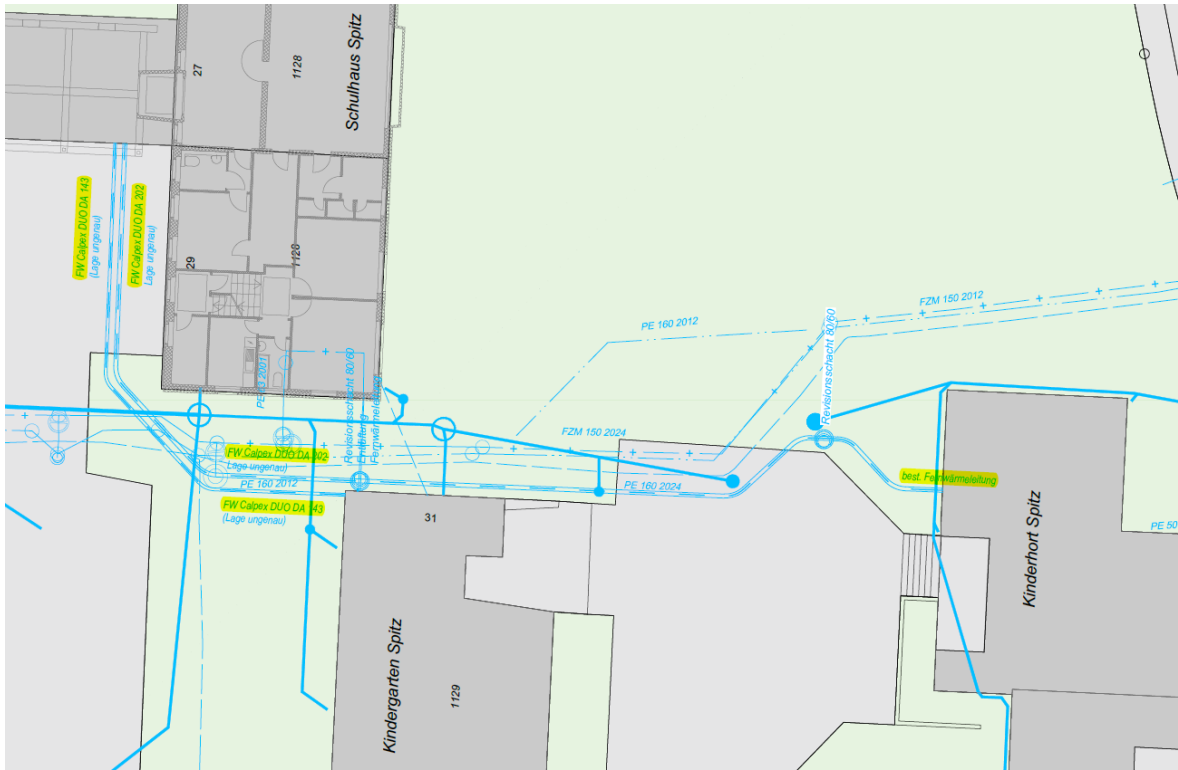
Bestehende Erschliessung KiGa und Hort
